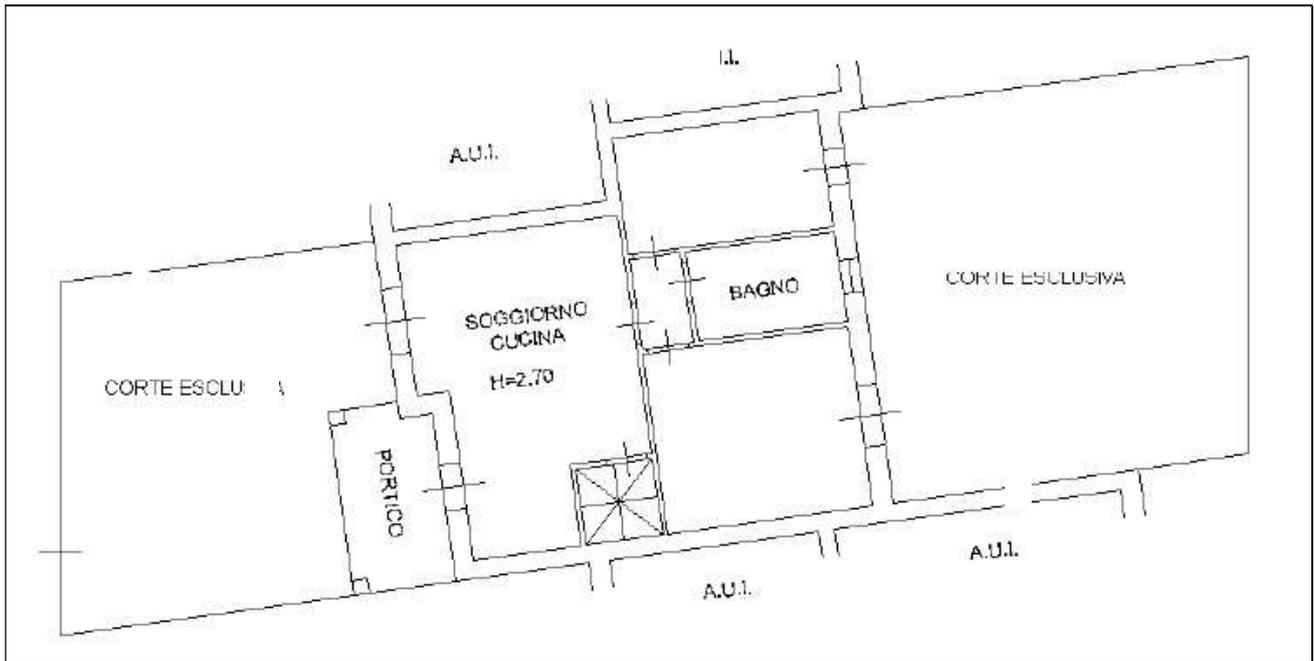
Estratto planimetria catastale Part. 883 sub. 8 -piano terra
